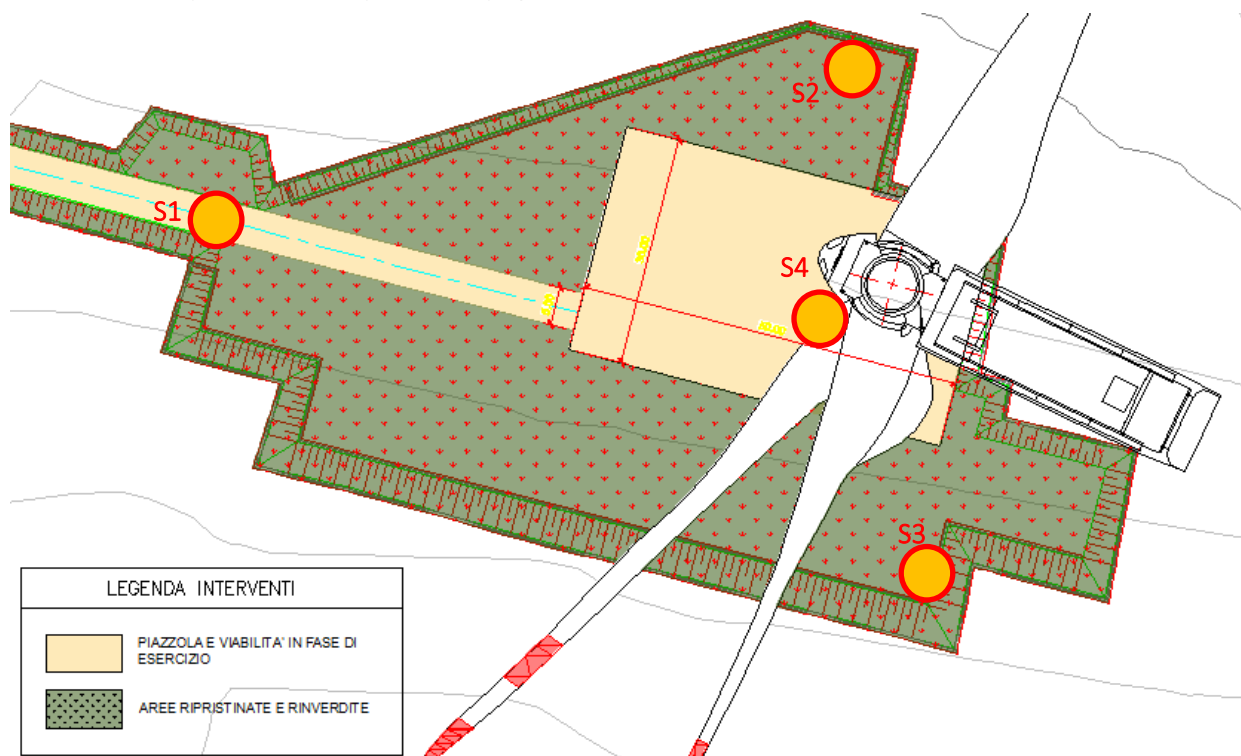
Schema di prelievo di campioni di terreno nelle piazzole (S1-S4)
